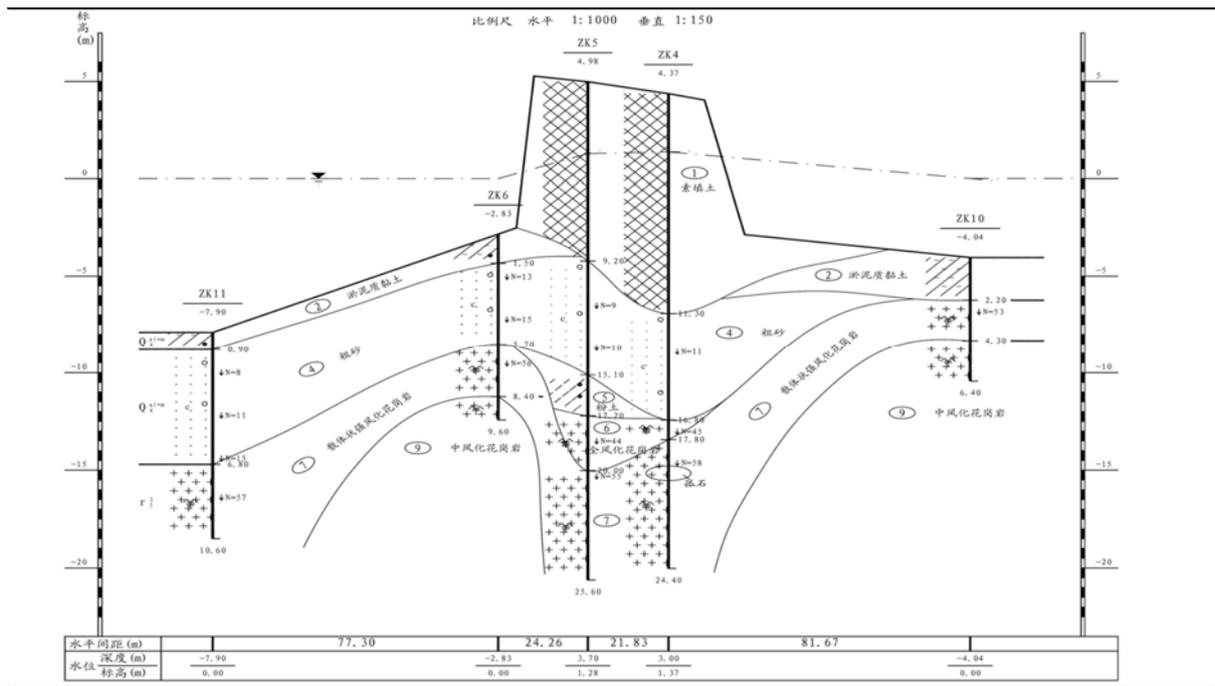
八尺门海堤钻孔剖面图 (二)
